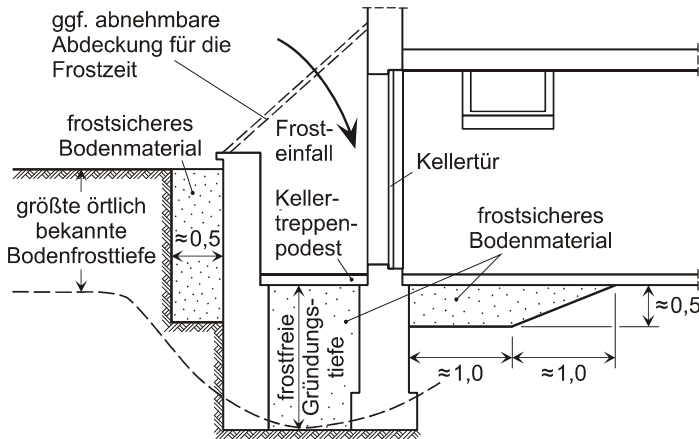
Ausbildung eines Kellereingangs mit Außentreppe zur Vermeidung von Frostschäden; alle Maße in m (nach [1])
